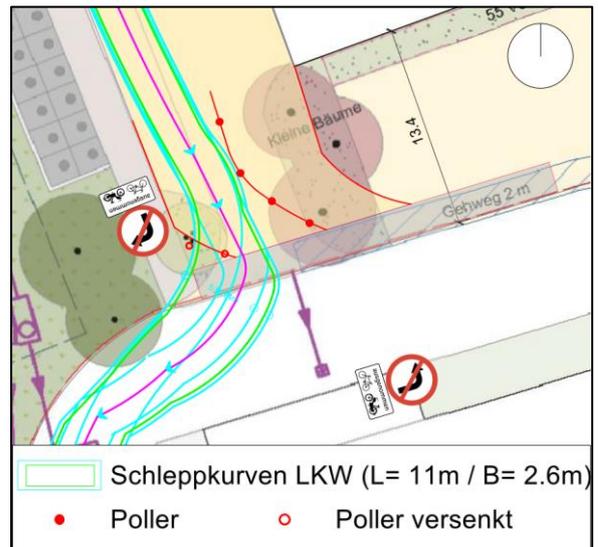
Wegfahrt Müllabfuhr / Blaulicht Stufe 2 (Poller);
